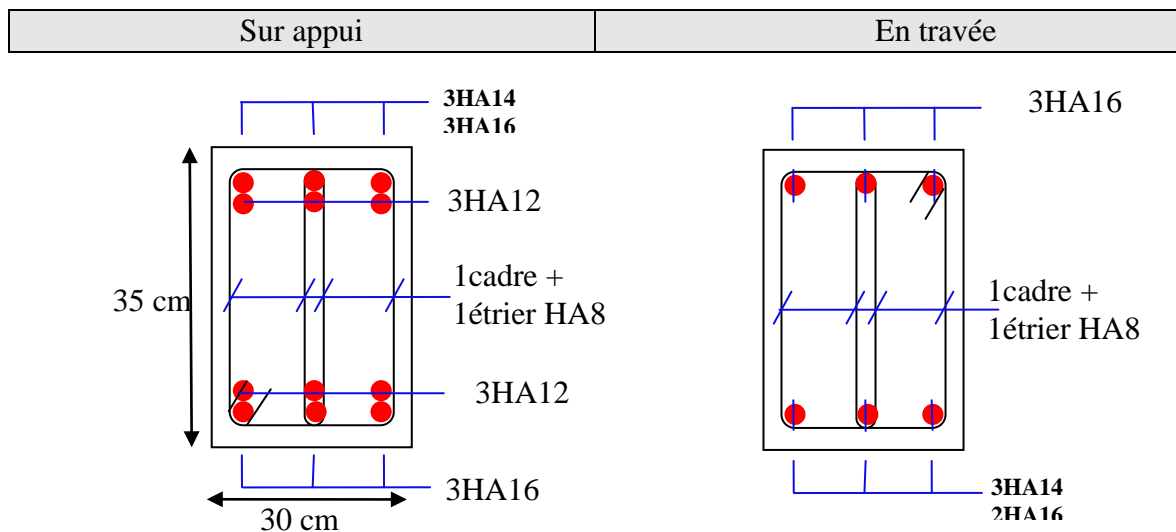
Ferraillage des poutres secondaires (30×35)
